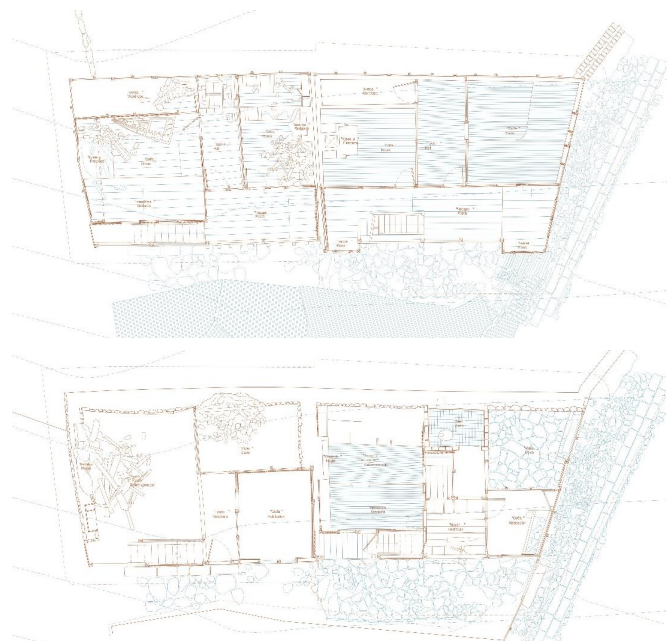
, plantas baja y primera, y alzado interno de las casas Kozichkovi.
